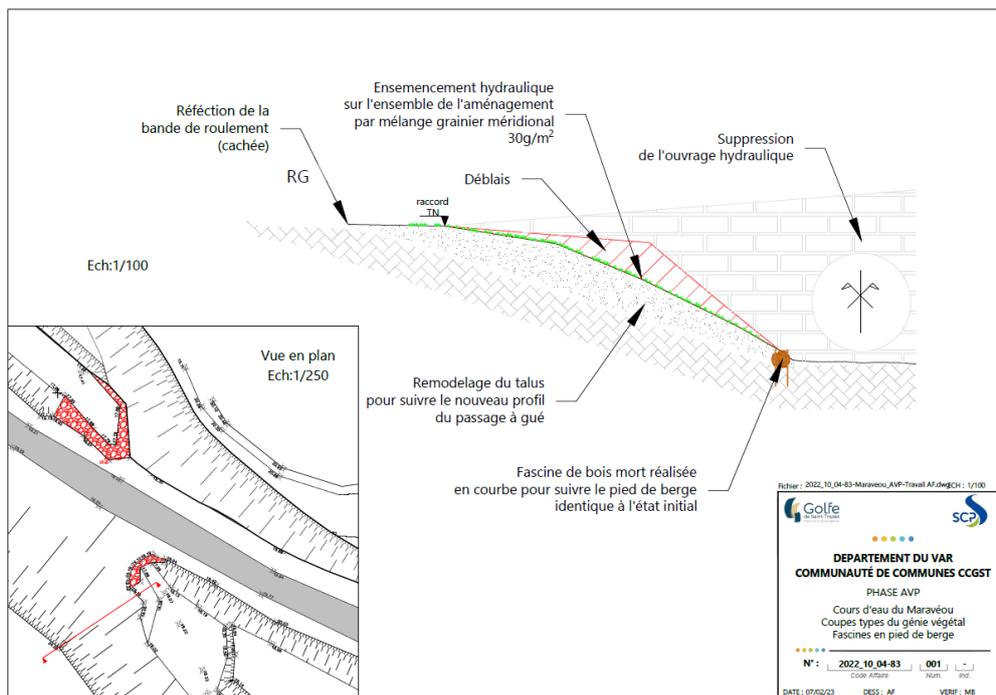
coupe type stabilisation pied de berge avec fascine inerte (exemple de photo à droite)
